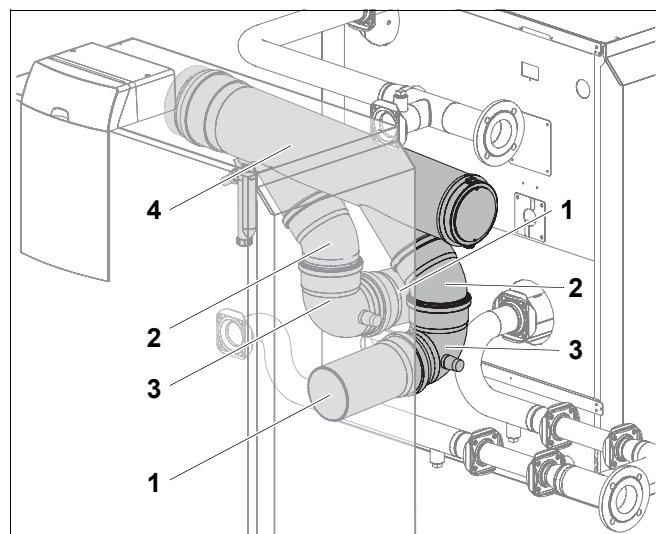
Монтаж дымовой трубы на установке с двумя котлами 180, 240 или 320 кВт
